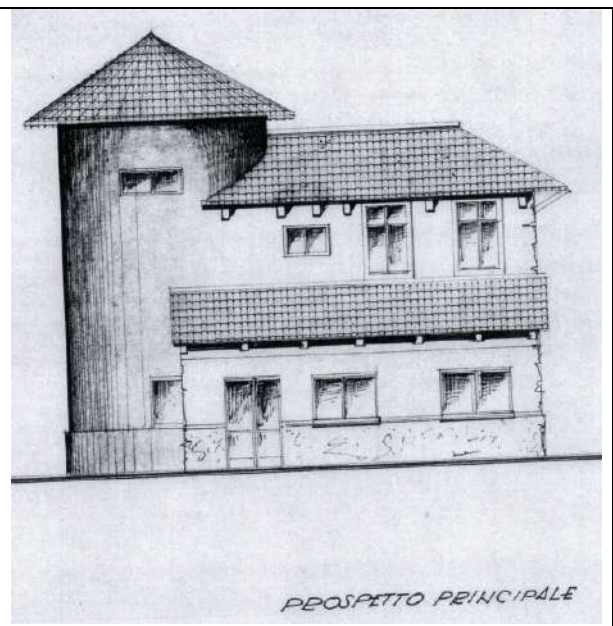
estratto dalla Licenza Edilizia n.2/1978 - prospetto principale
